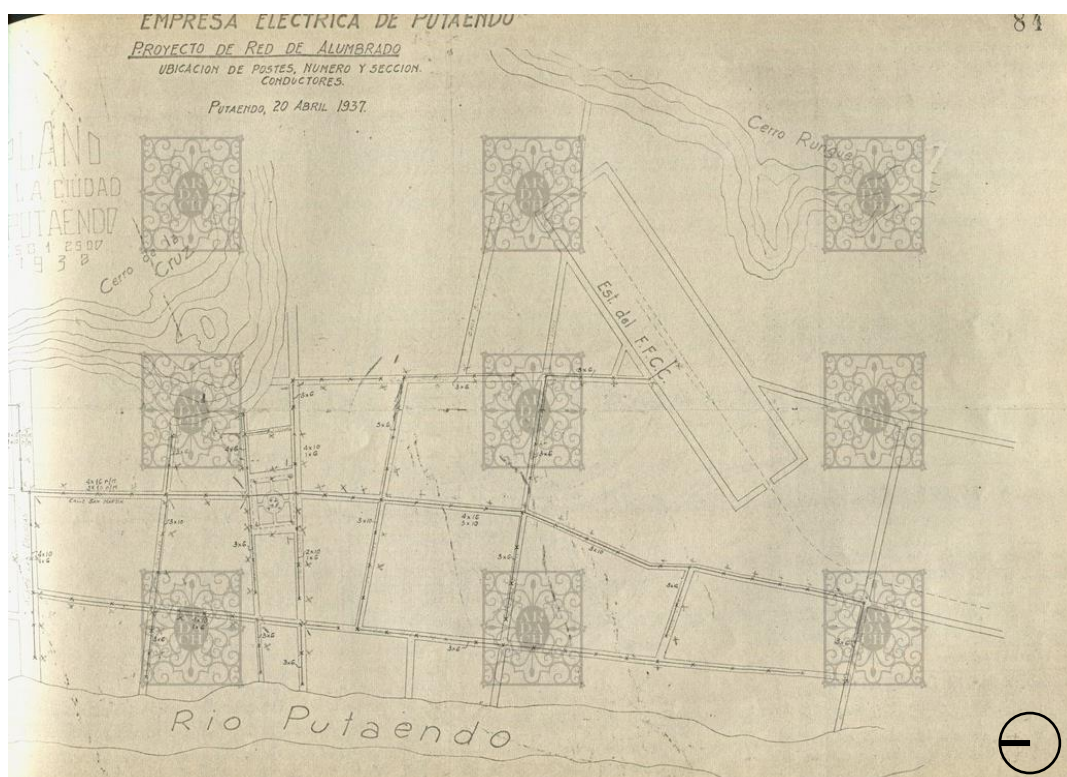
Plano empresa Eléctrica de Putaendo, año 1932.
